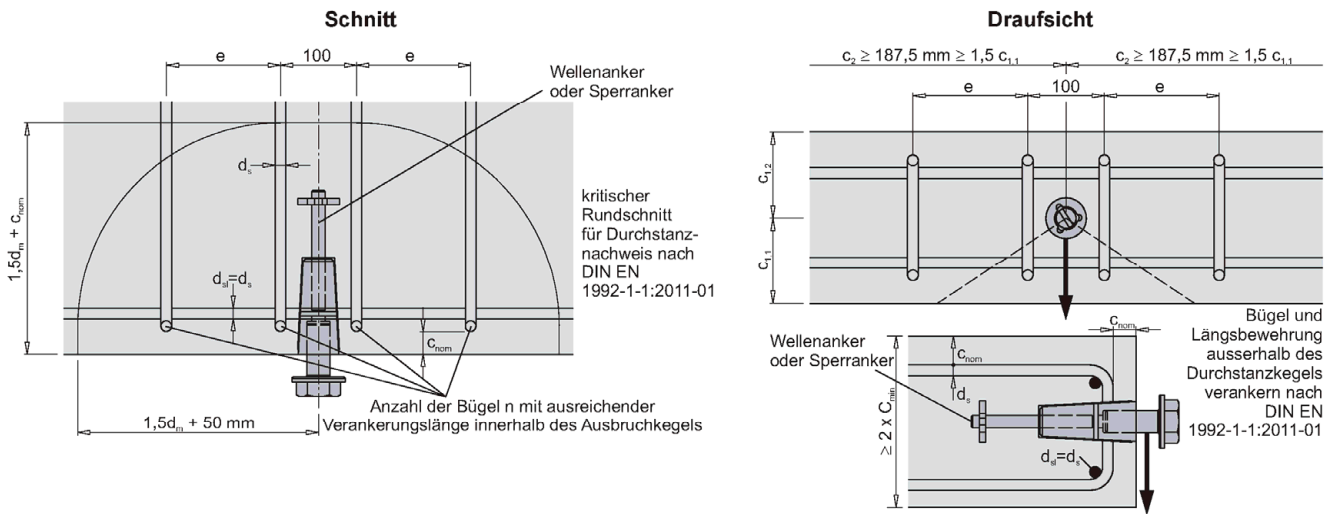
Einbausituation Stirnseite - Querbeanspruchung mit Rückhängebewehrung - Bewehrungslage
